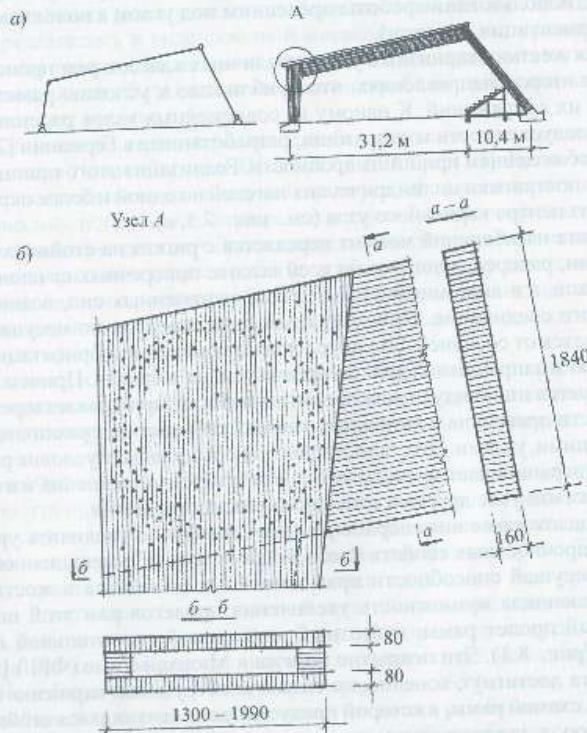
Рама каркаса манежа в Мюнхен-Римме: а – схема и общий вид поперечника здания; б – карнизный узел рамы на 114 нагелях диаметрами 12 и 20 мм
